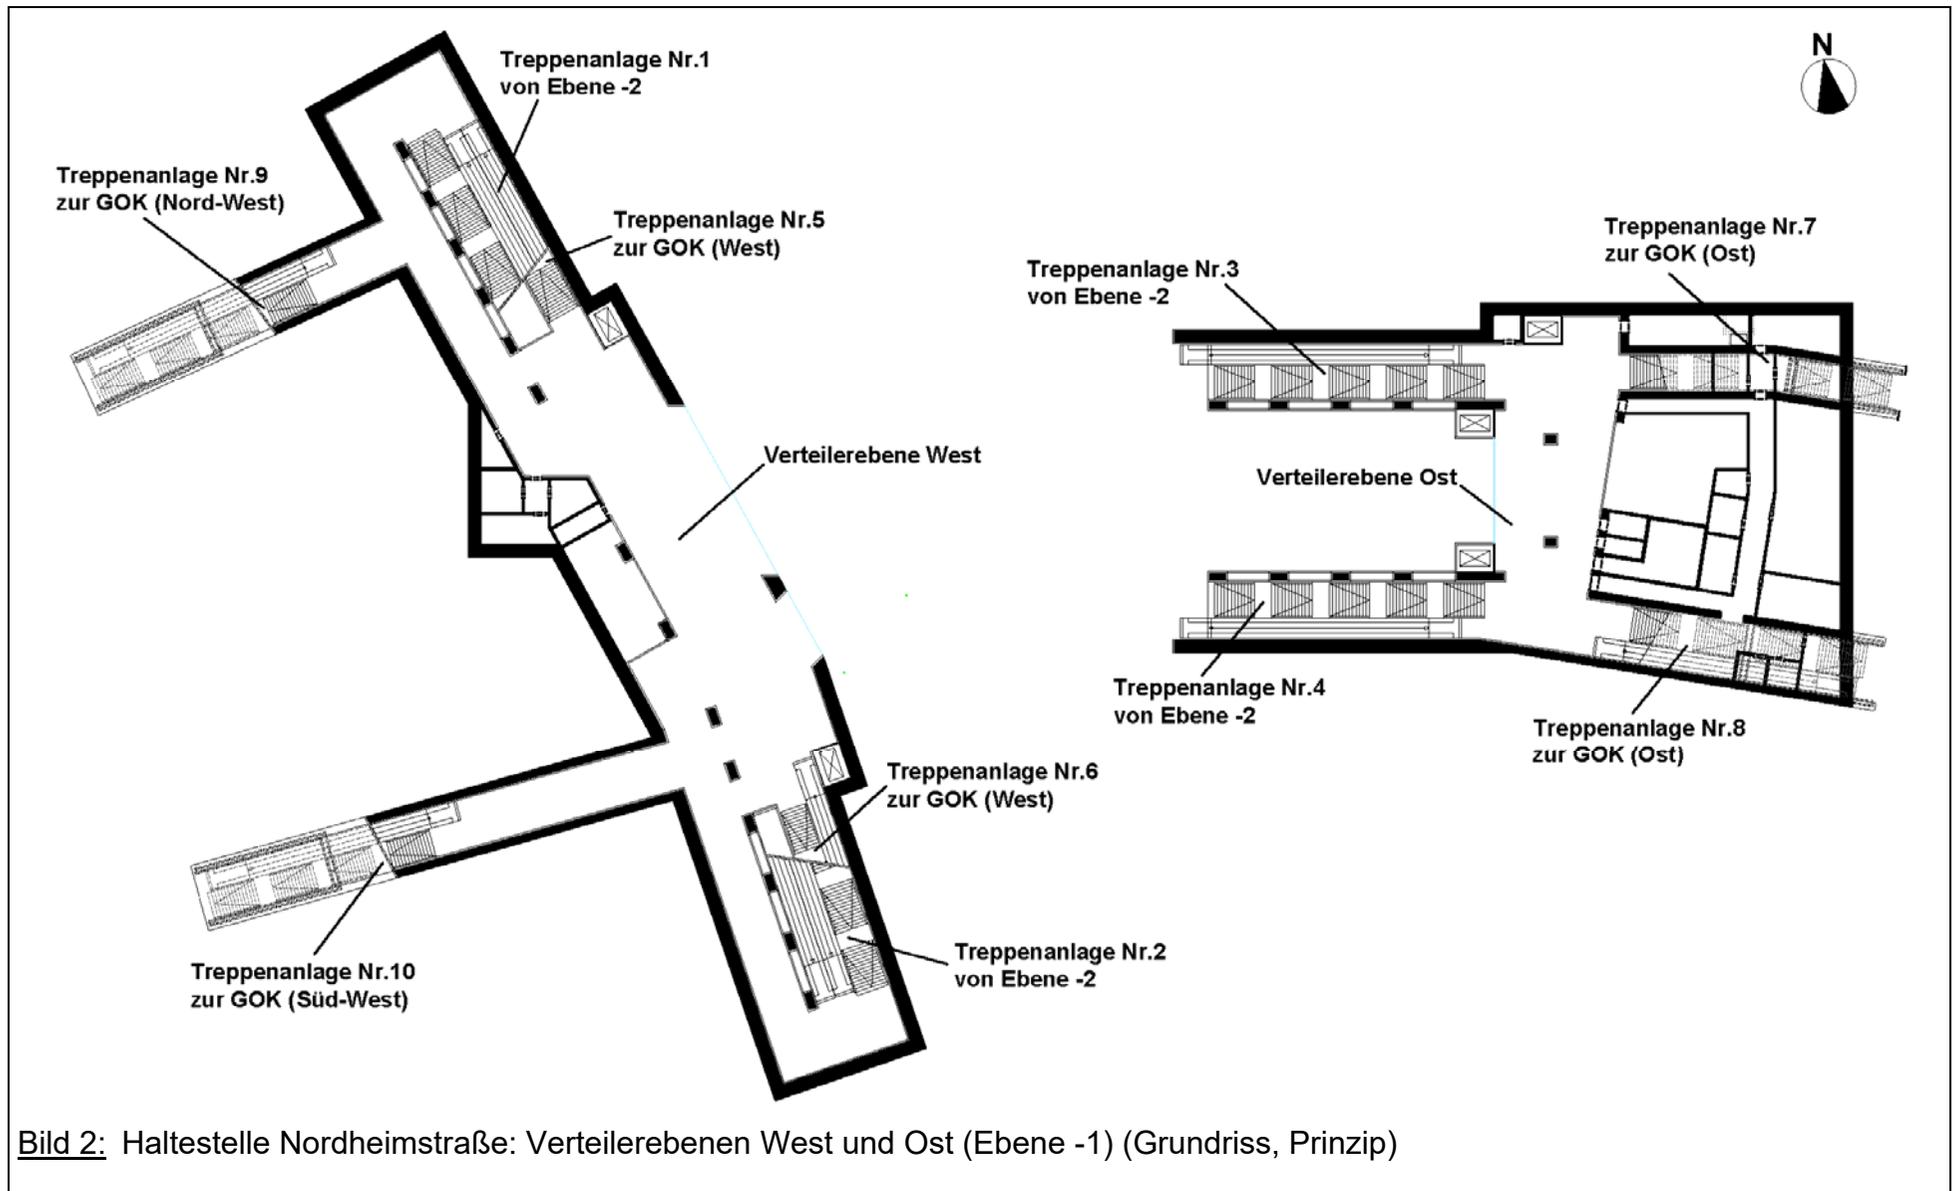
Haltestelle Nordheimstraße: Verteilerebenen West und Ost (Ebene -1) (Grundriss, Prinzip)
